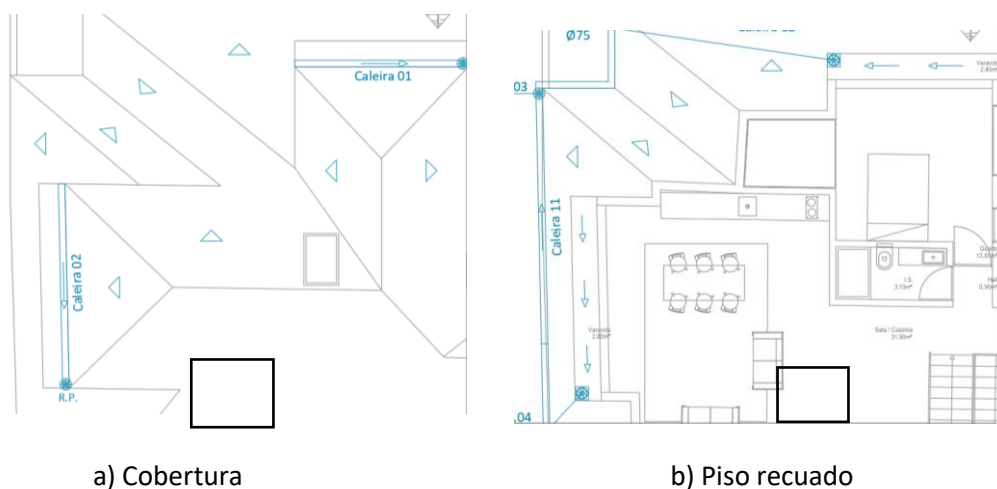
Drenagem de águas pluviais na cobertura.
